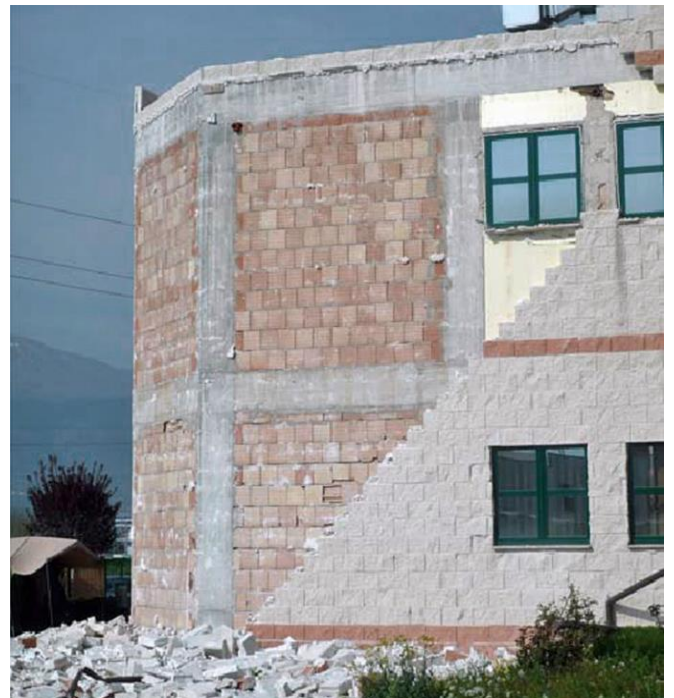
> Einsturz einer vorgemauerten Fassade
